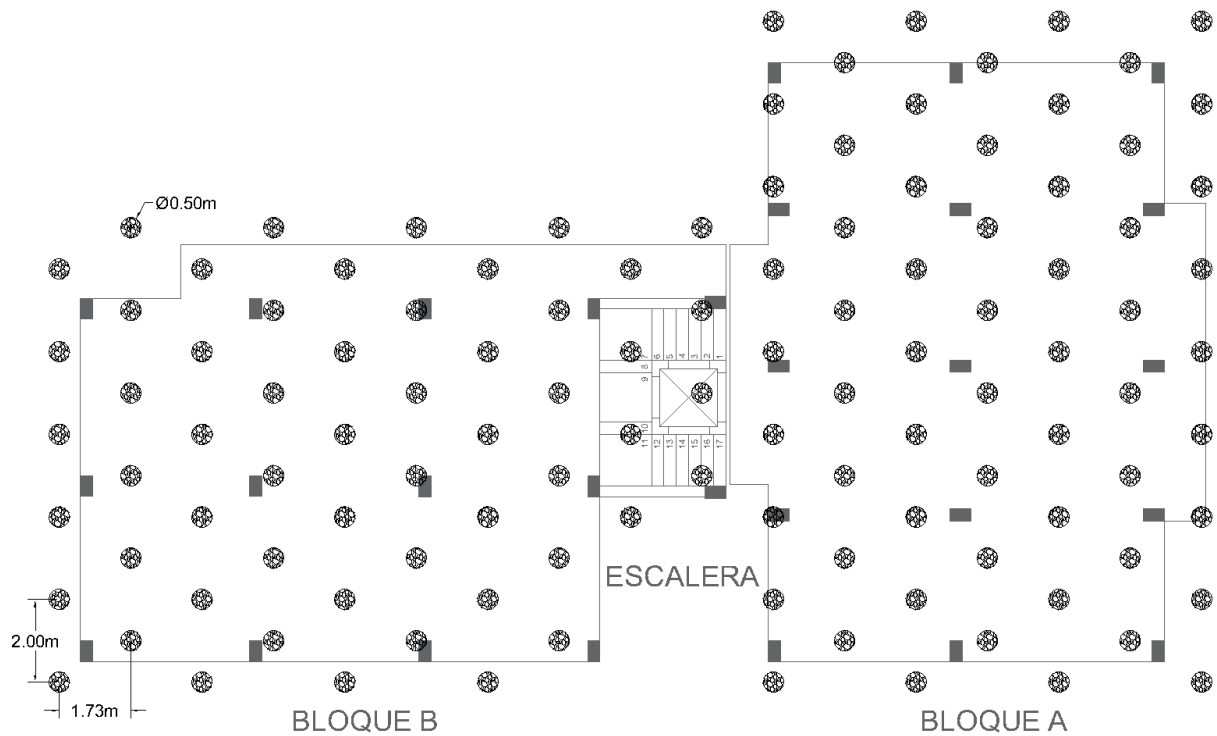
Distribución de columnas de grava. Fuente: (Andrade S. & Carranza R., 2019)
